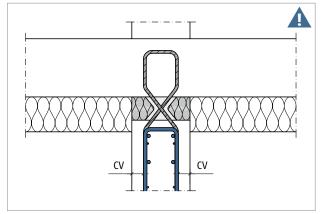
Schöck Sconnex® Typ W-N-VH: Variante B (für geringe Wanddicken) – bauseitige Bewehrung; die Längsbewehrung stützt die Querkraftstäbe des Schöck Sconnex® gegen das Innere des Stahlbetonbauteils ab
